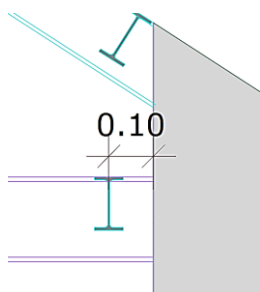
Distância entre eixo do perfil secundário e viga de betão
